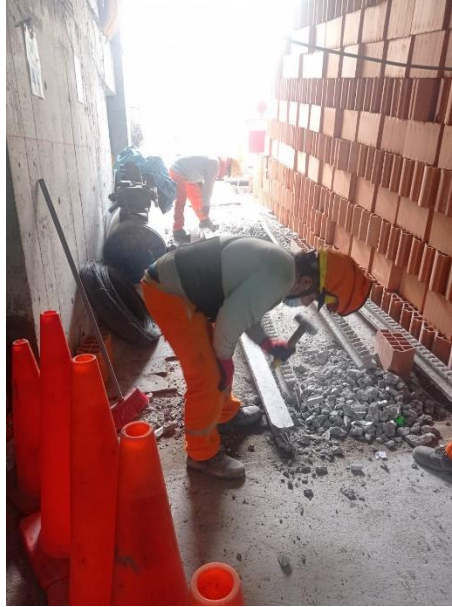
Generación de escombros de viguetas pretensadas de concreto
